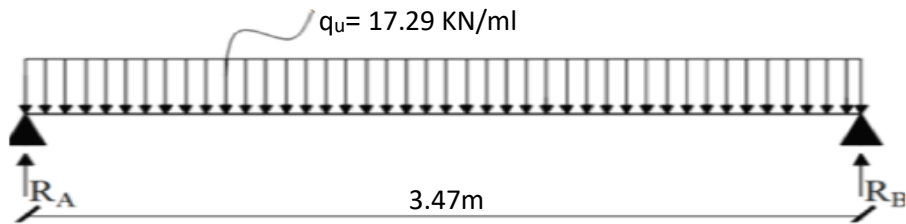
Schéma statique de la poutre de chaînage à l'ELU
